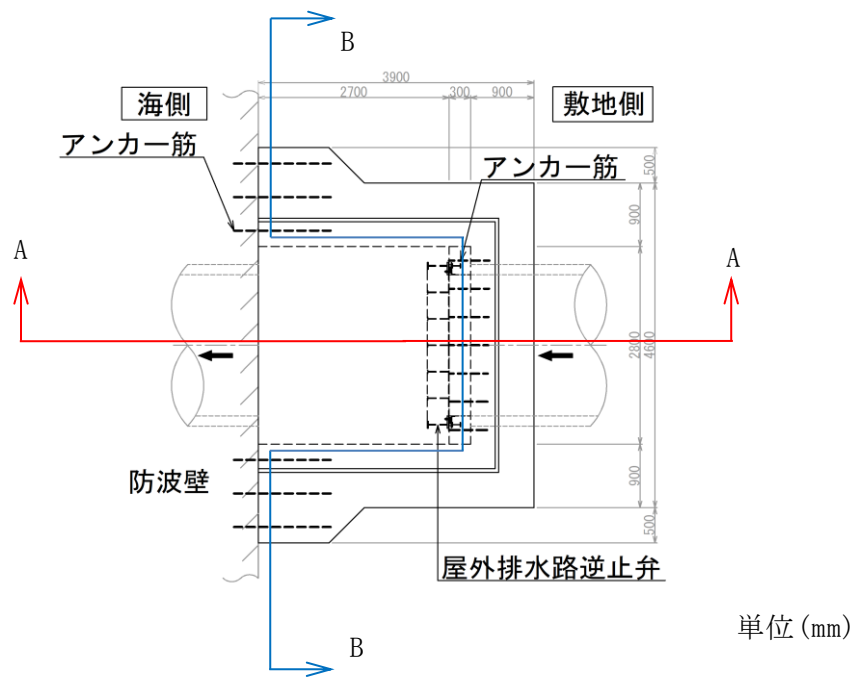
(3) 投 屋外排水路逆止弁①集水桝構造図 (平面図)
